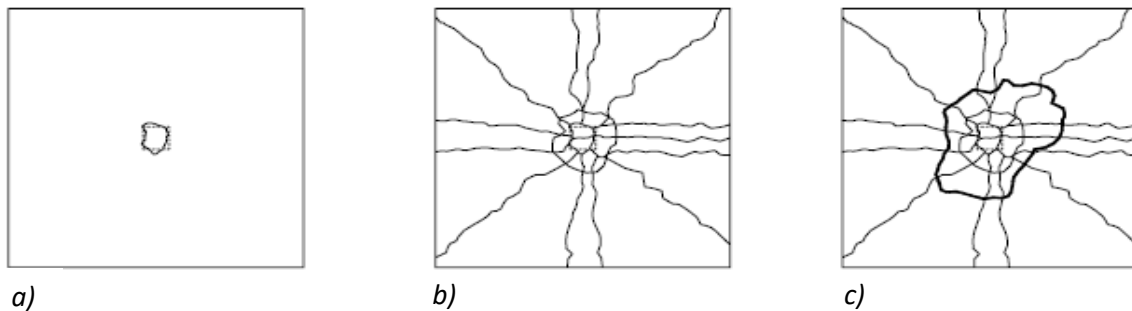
Evolution des fissures sur la face tendue d'une dalle pendant la mise en charge [87]
